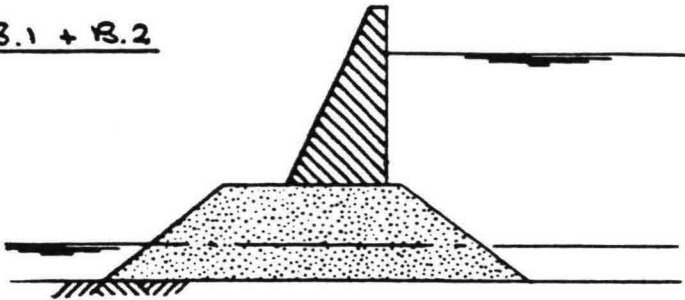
Alternatieve waterkeringen, bld 3
